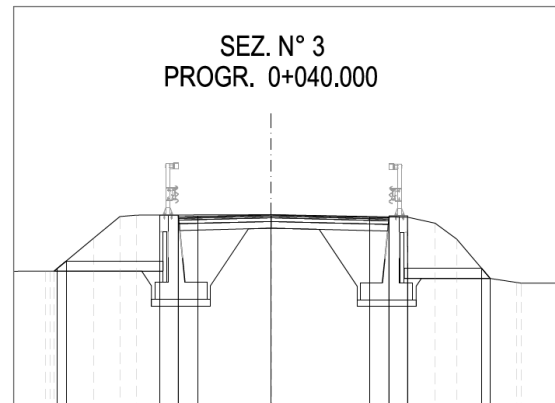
Sezione del rilevato su lato nord in approccio al nuovo ponte di Final di Rero (via del Mare)
